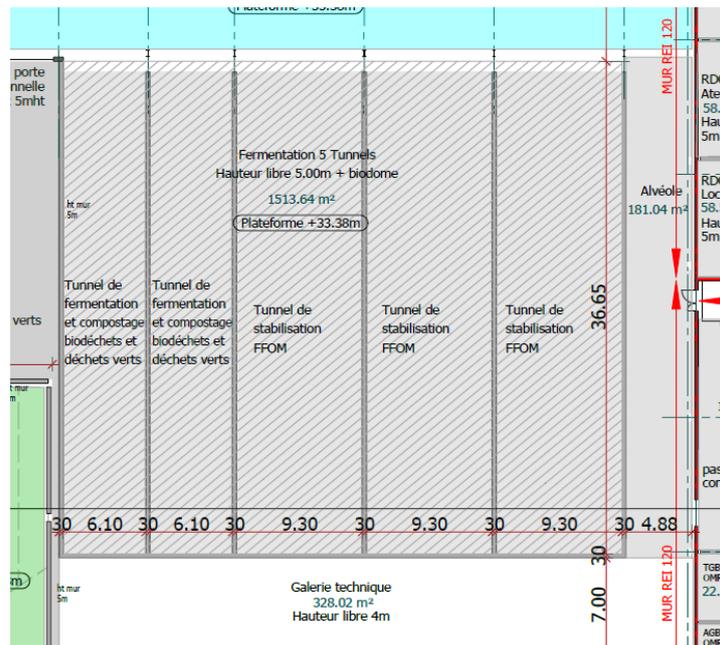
Configuration des tunnels de stabilisation de FFOM
